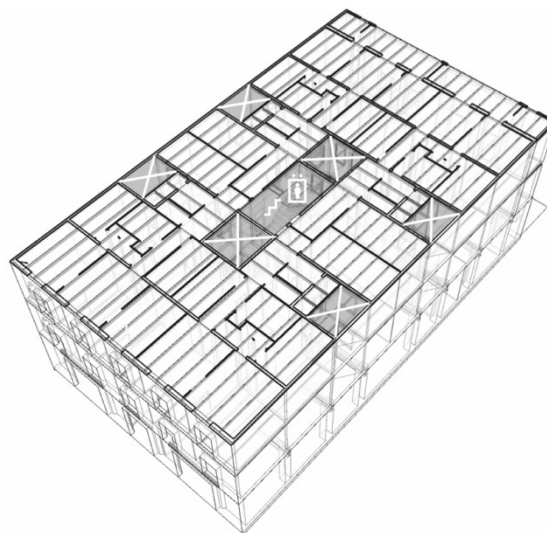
Patios de luces internos distribuidos en planta (fuente: preparado por el autor)
